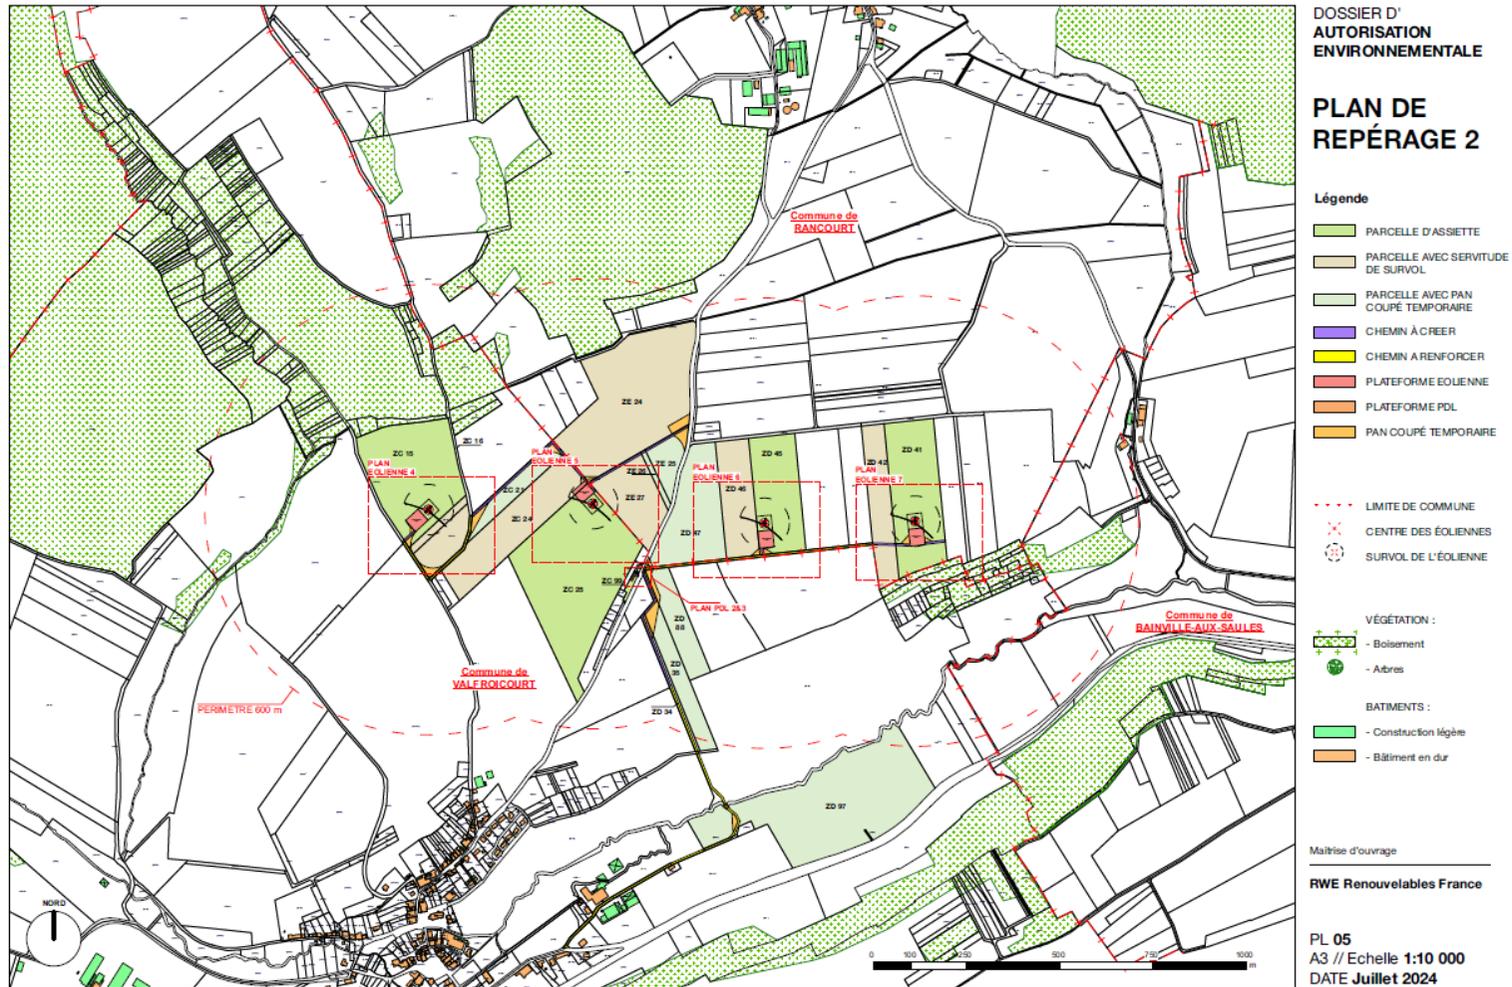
Plan de repérage n°2 du Parc Éolien des Baumes
